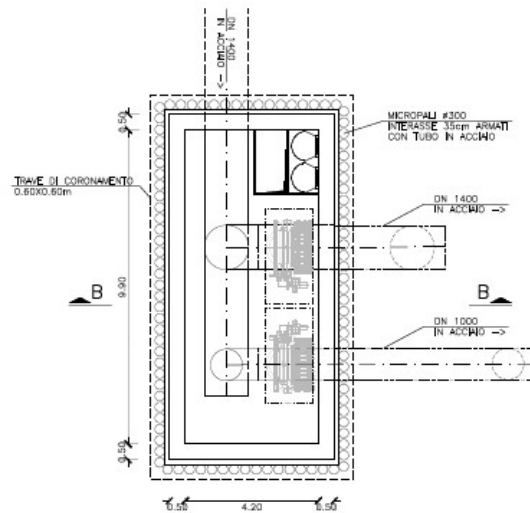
Pianta e sezione del Pozzo Pineta Pestalozzi
